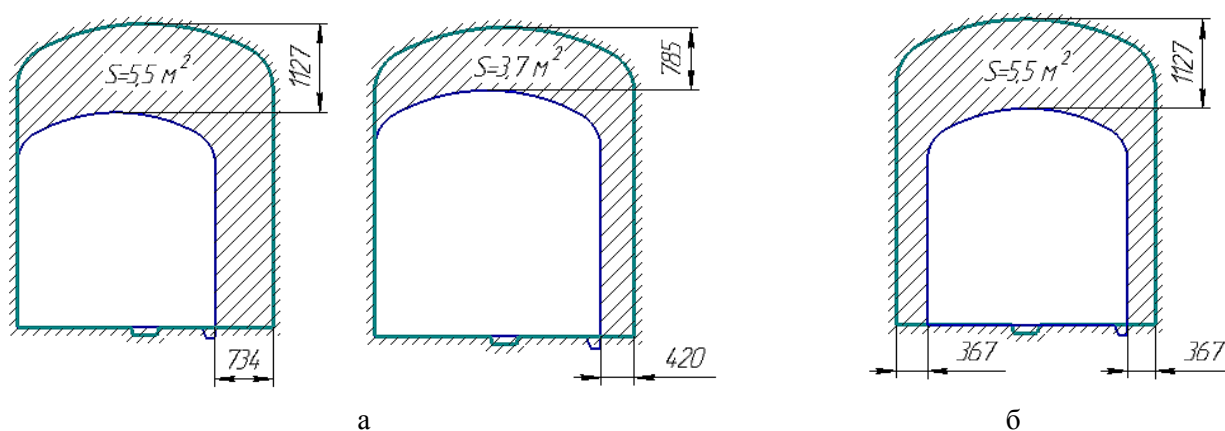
Поперечное сечение выработок с учетом расширения сечения: а – одной стенки и свода; б – двух стенок и свода
